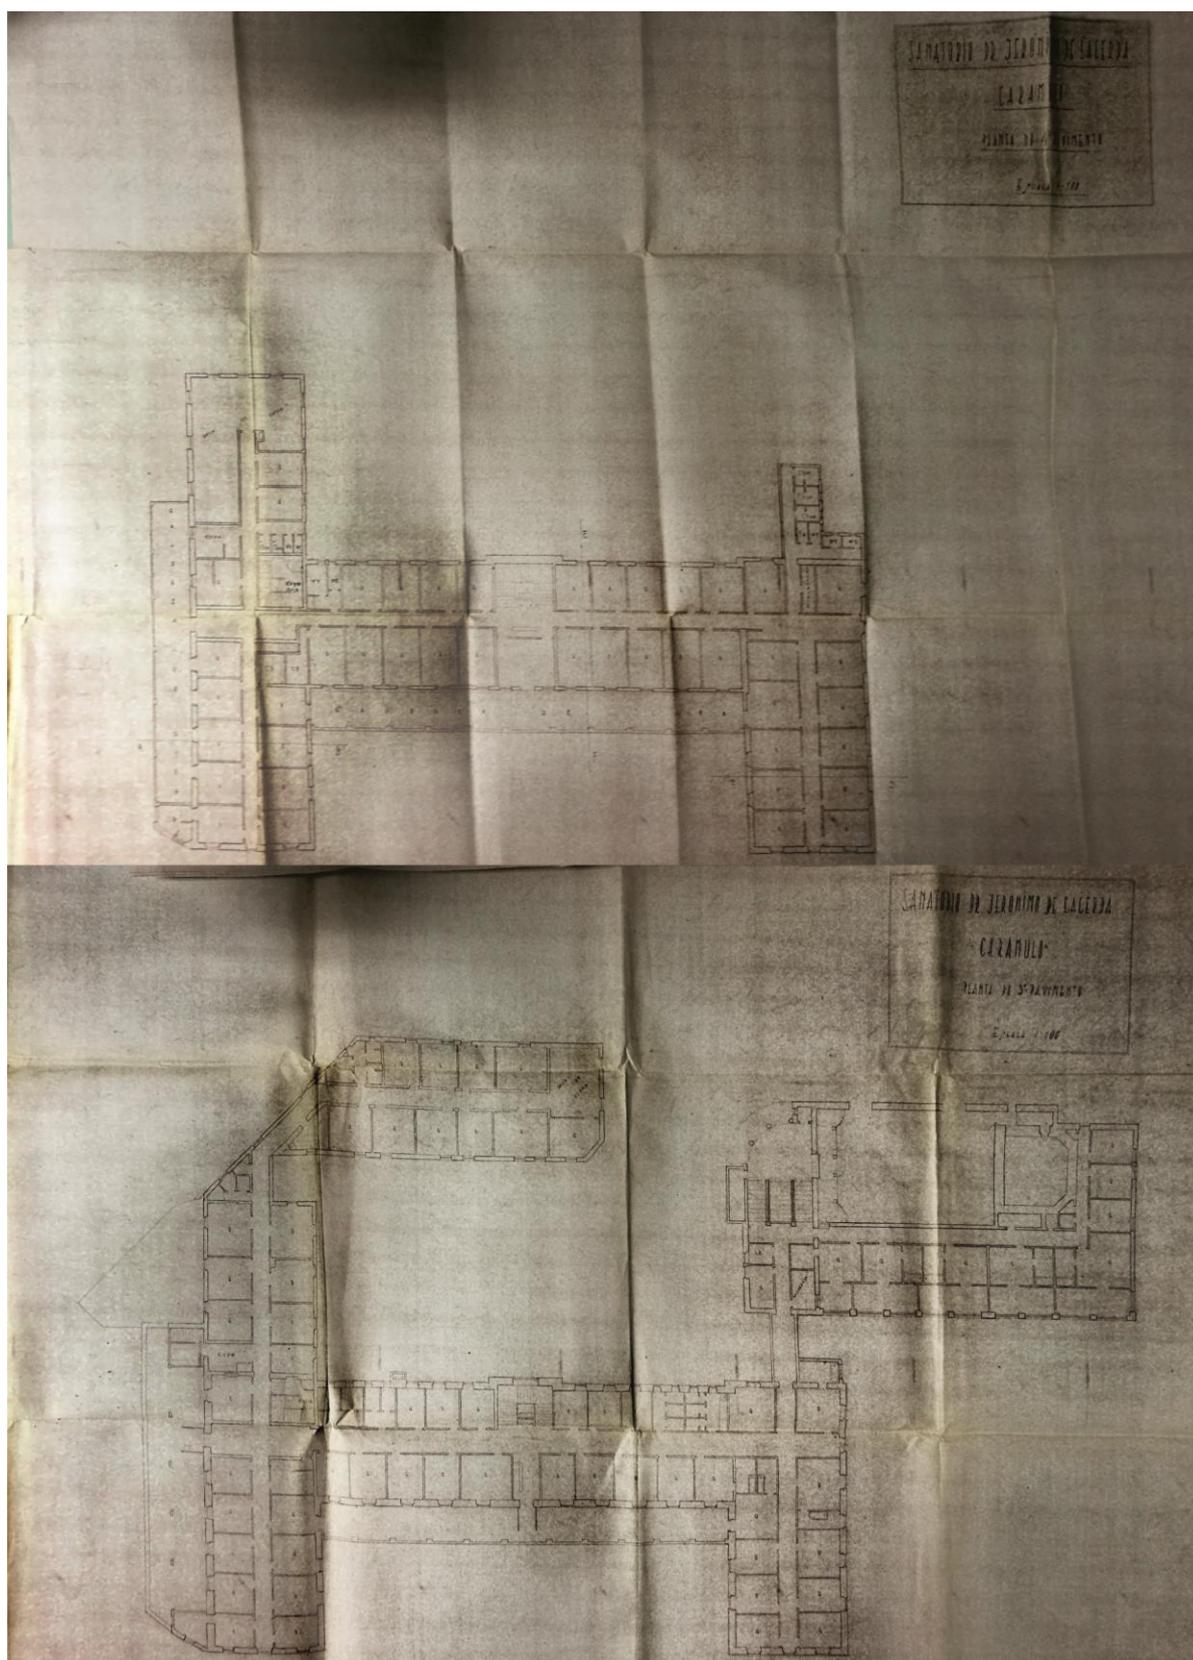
Plantas dos 3º e 4º piso referente a 3ª fase de construção (gentilmente cedido pela família Lacerda)
